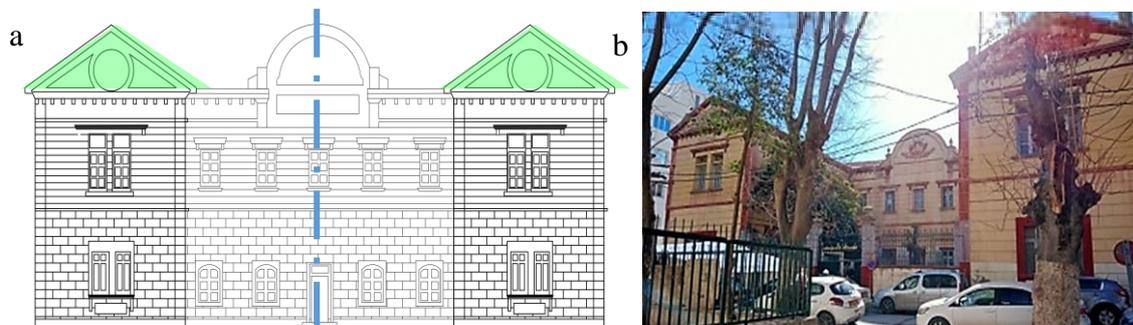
a) La façade principale du collège (auteure, 2023) ; (b) photo récente (auteure, 2023)
